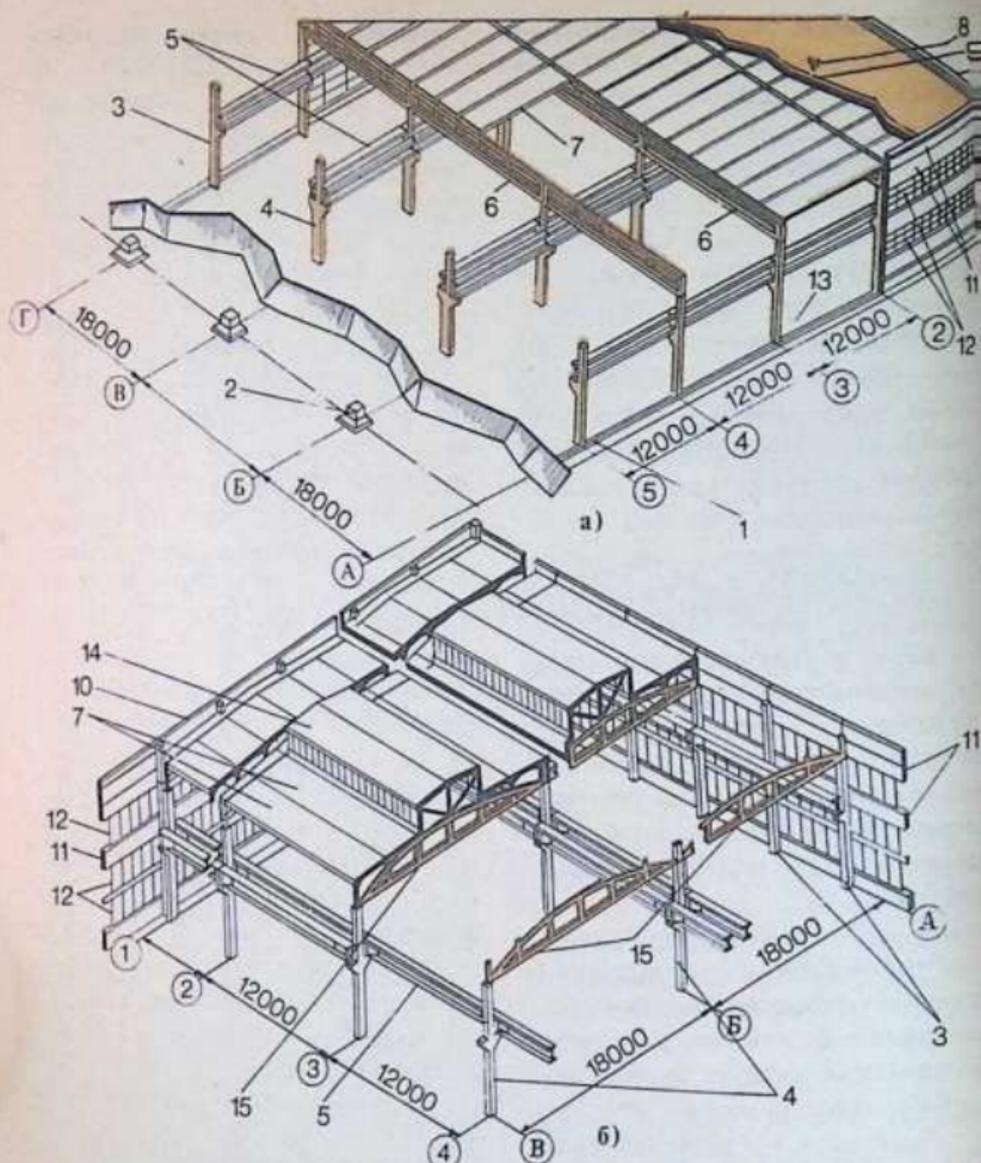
Схемы каркасов одноэтажных промышленных зданий:
